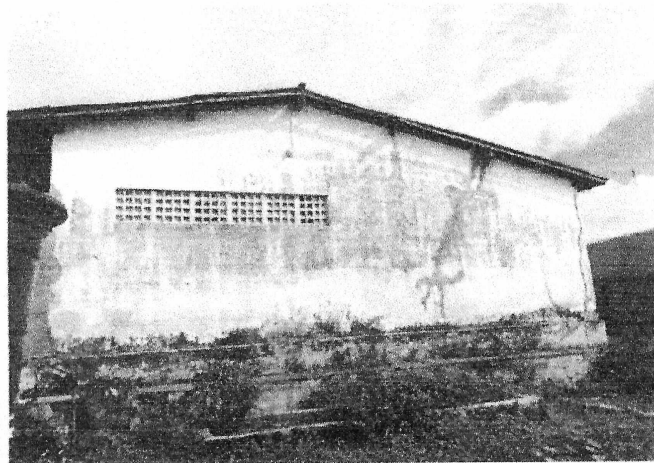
Fachada externa da edificação, indicando elevada necessidade de intervenções construtivas.
